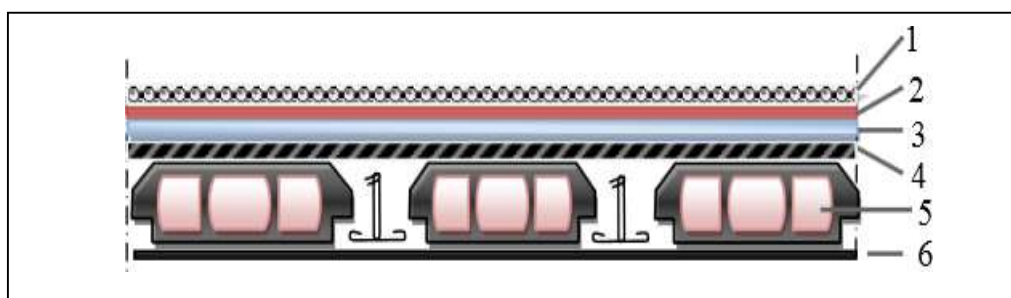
Détail des constituants du plancher terrasse inaccessible.
